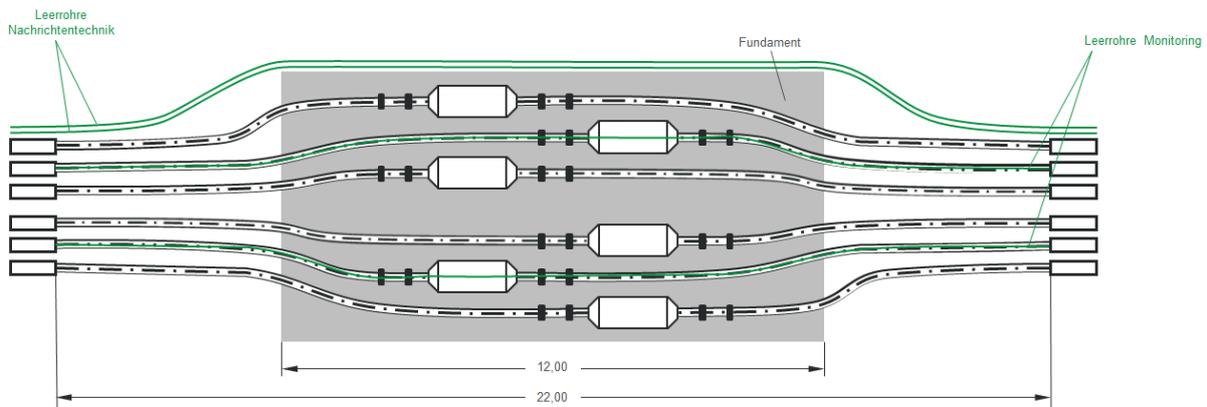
Muffengrube für Teilerdverkabelungsabschnitt, Draufsicht
